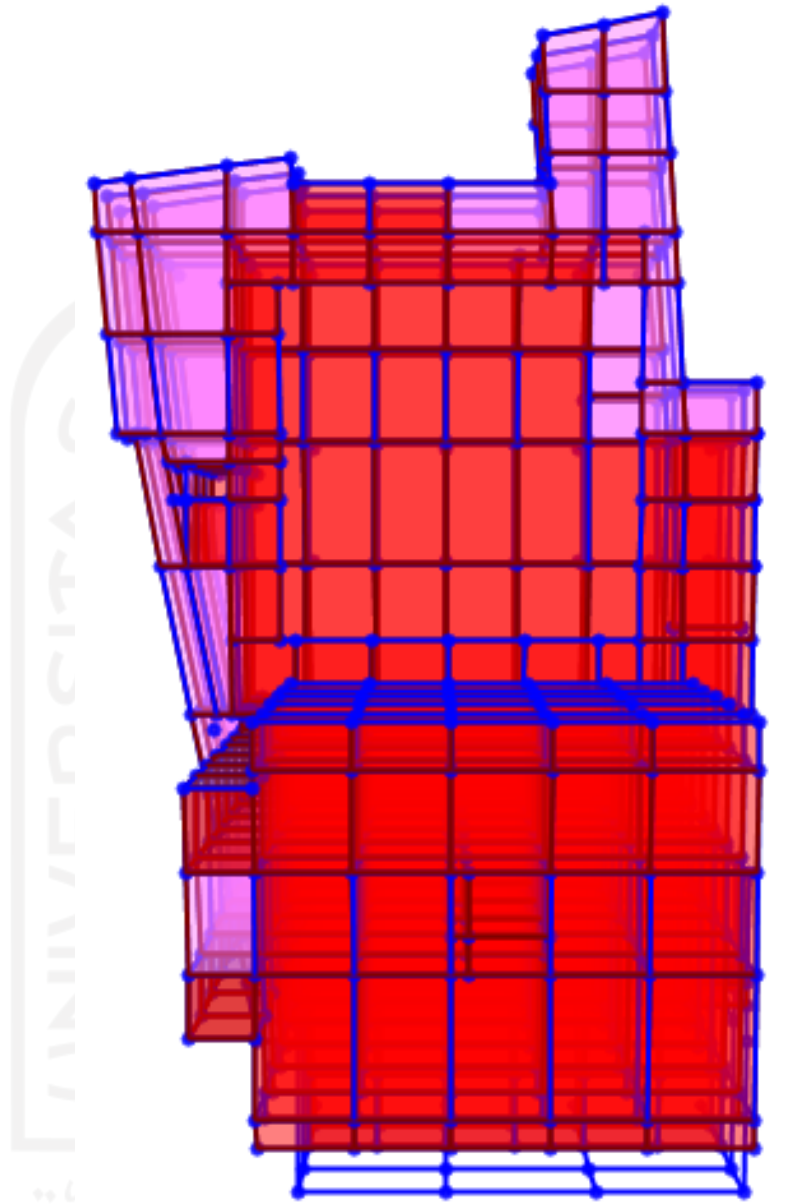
7 Model 3D Struktur Dengan Corewall Tampak Samping
